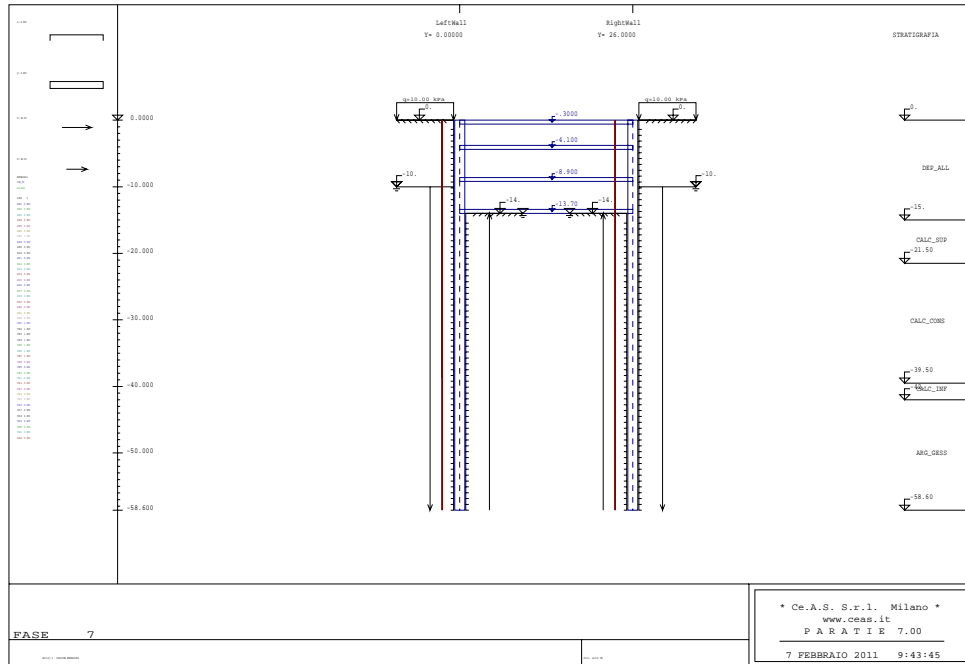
Fase 7: Getto solaio a +53.91m s.l.m.
